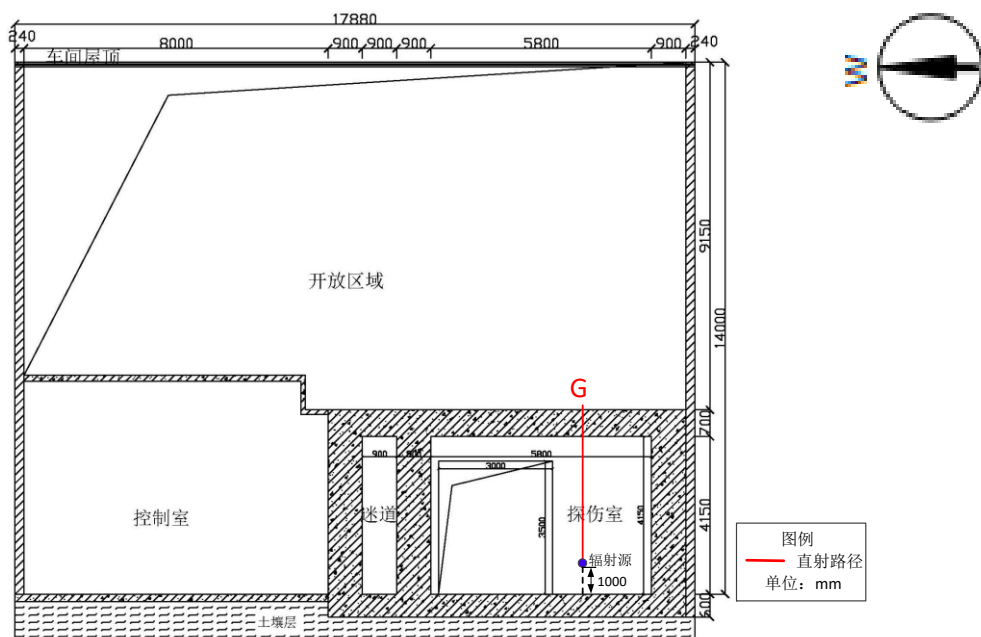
探伤室平面设计及预测点位示意图（单位：mm）
